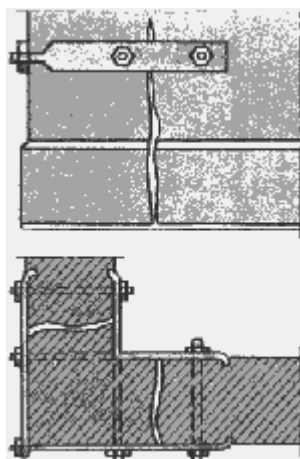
Усиление кирпичной стены металлическими накладками при отрыве угла.
